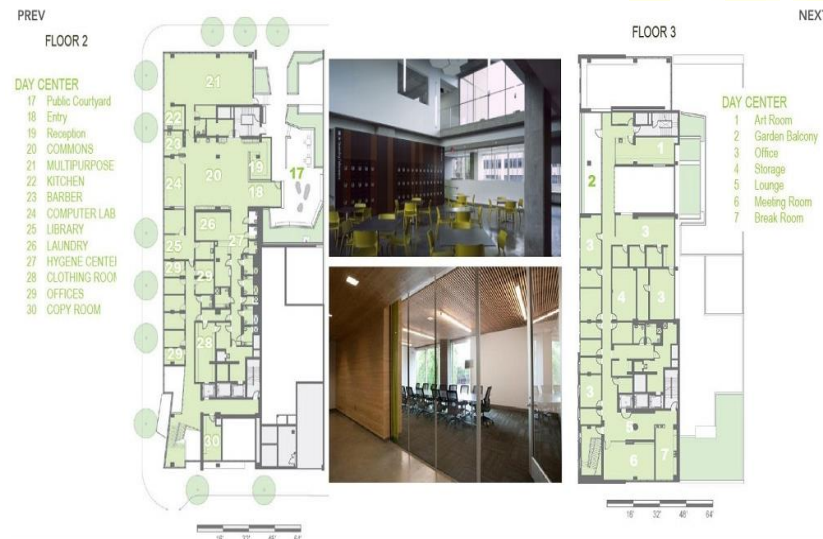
Planta baixa pavimentos 02 e 03 e fotos do local
